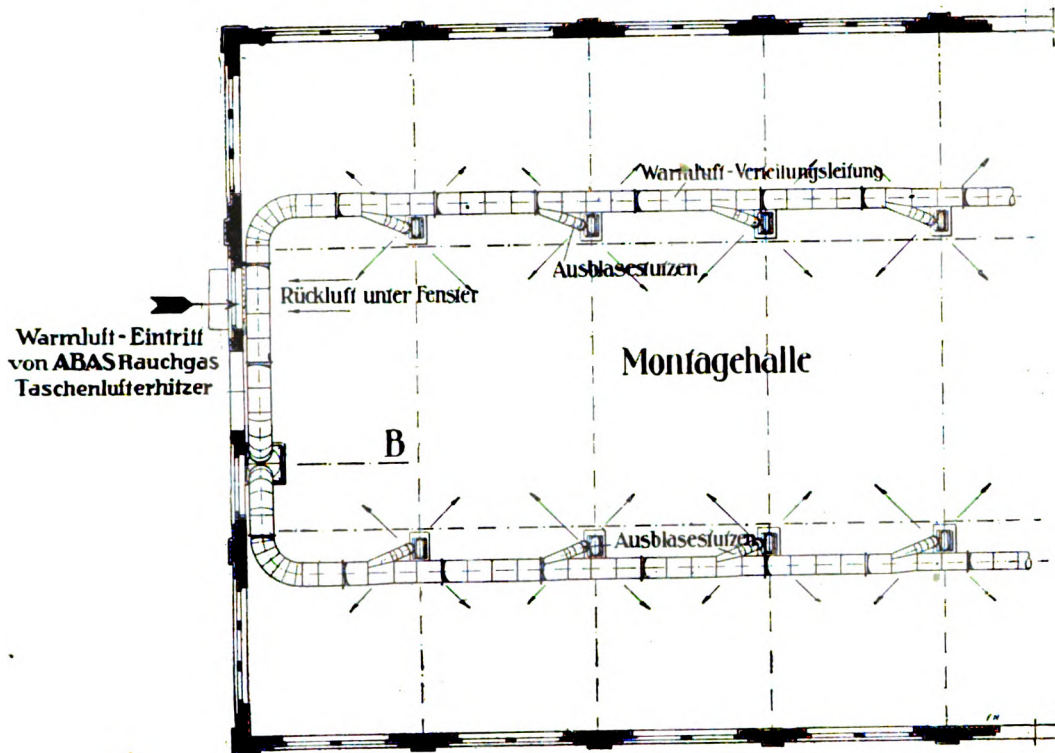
Grundriß einer Luftheizungsanlage unter Verwendung von Rauchgas-Abwärmeausnutzung.
